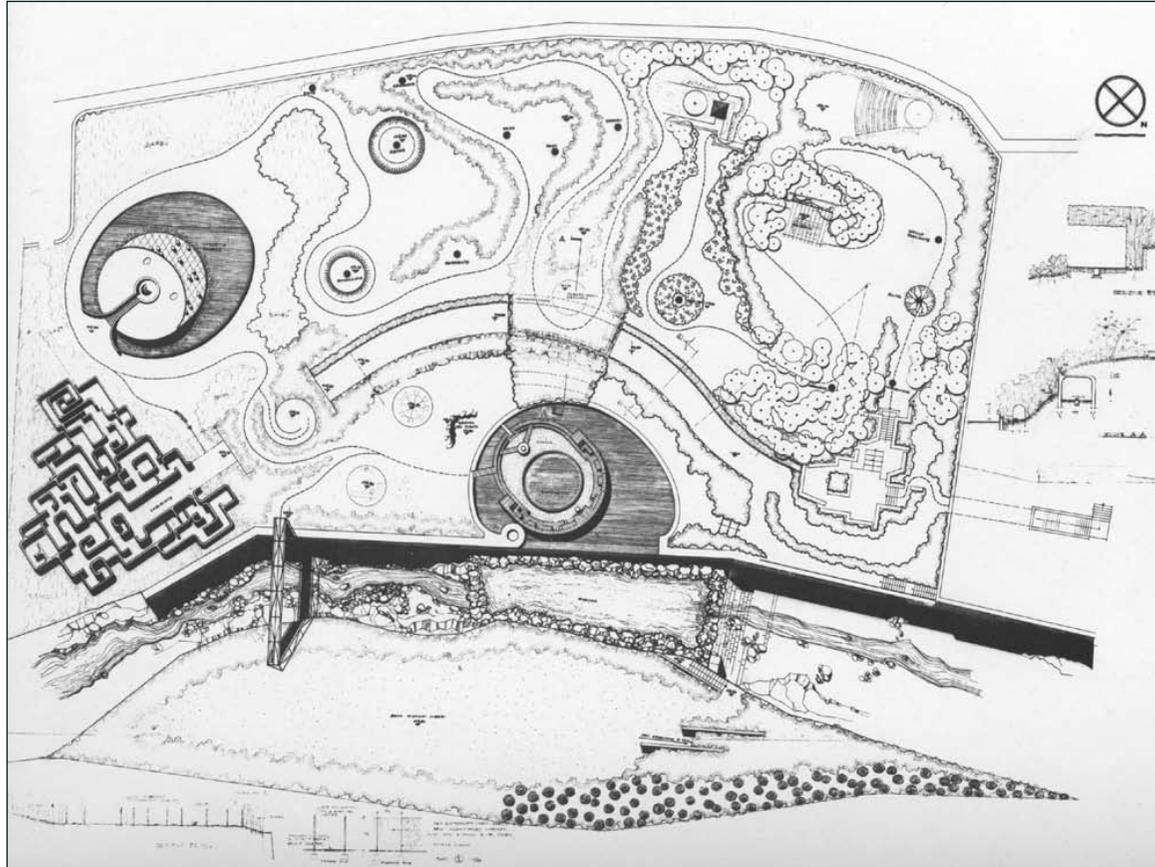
Grundriss Pinocchio Park, 1956
